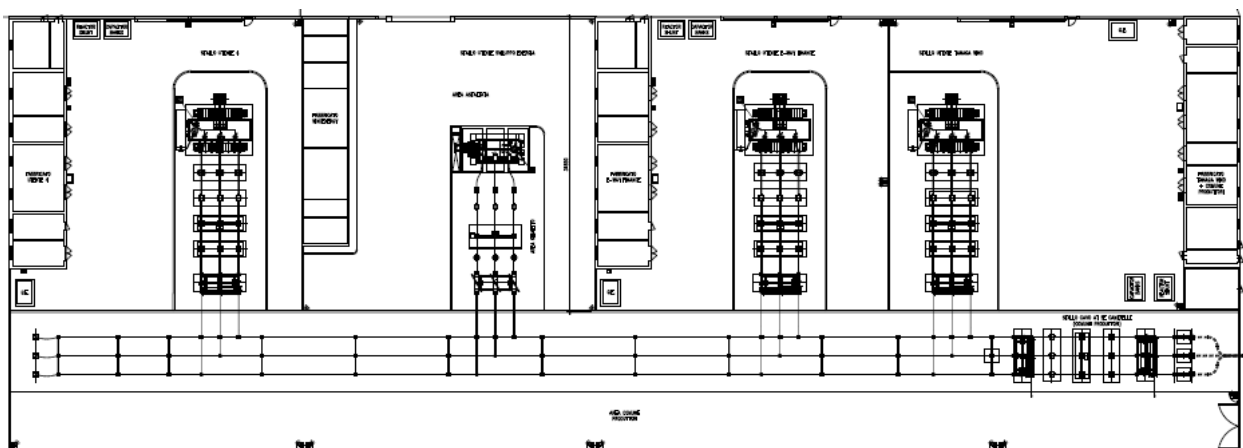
Stralcio planimetrico Punto di Raccolta 150kV
